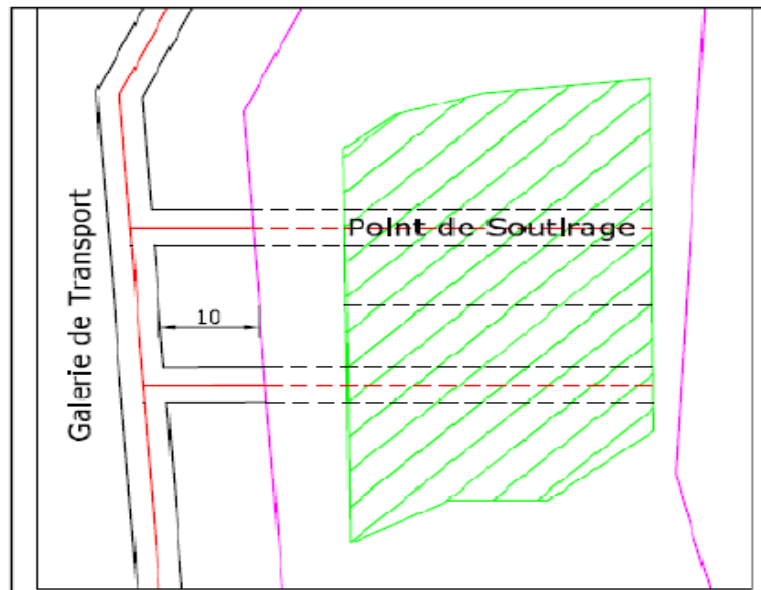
Vue en plan, chantier type (Amec, 2011).
